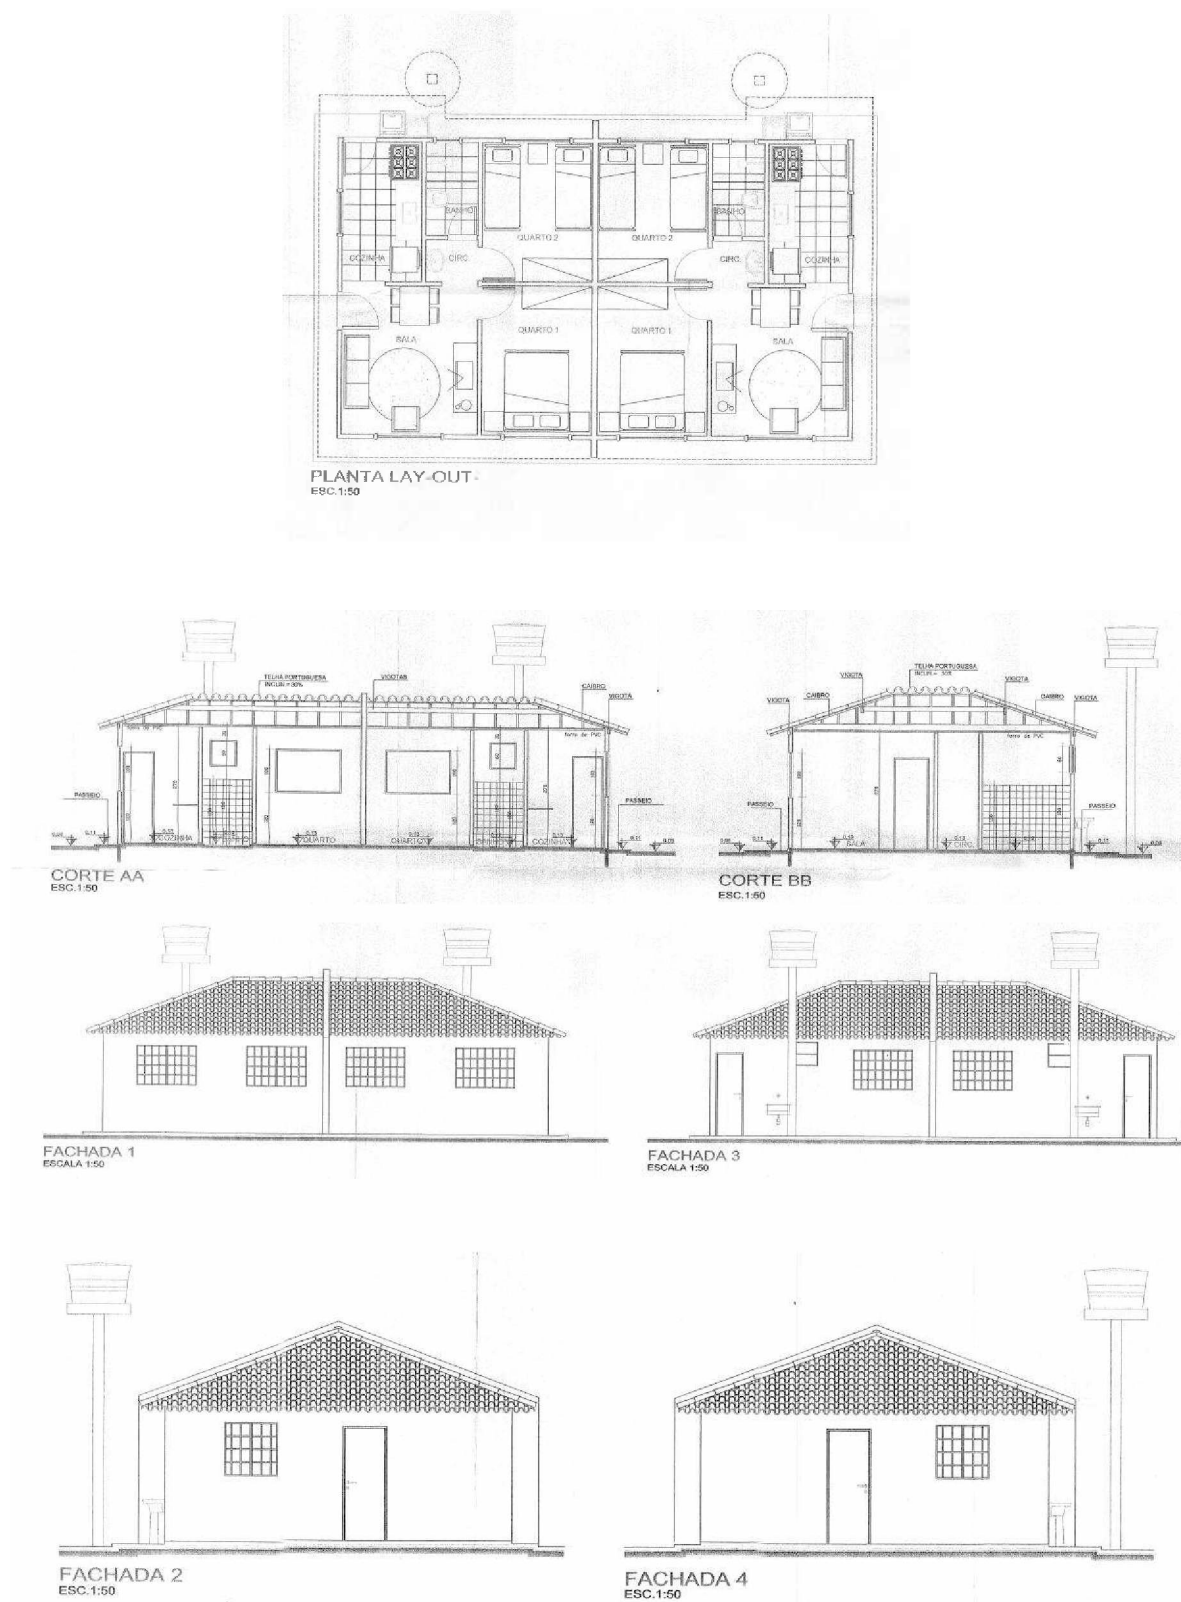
Planta Unidade Habitacional (layout, cortes e fachadas).
